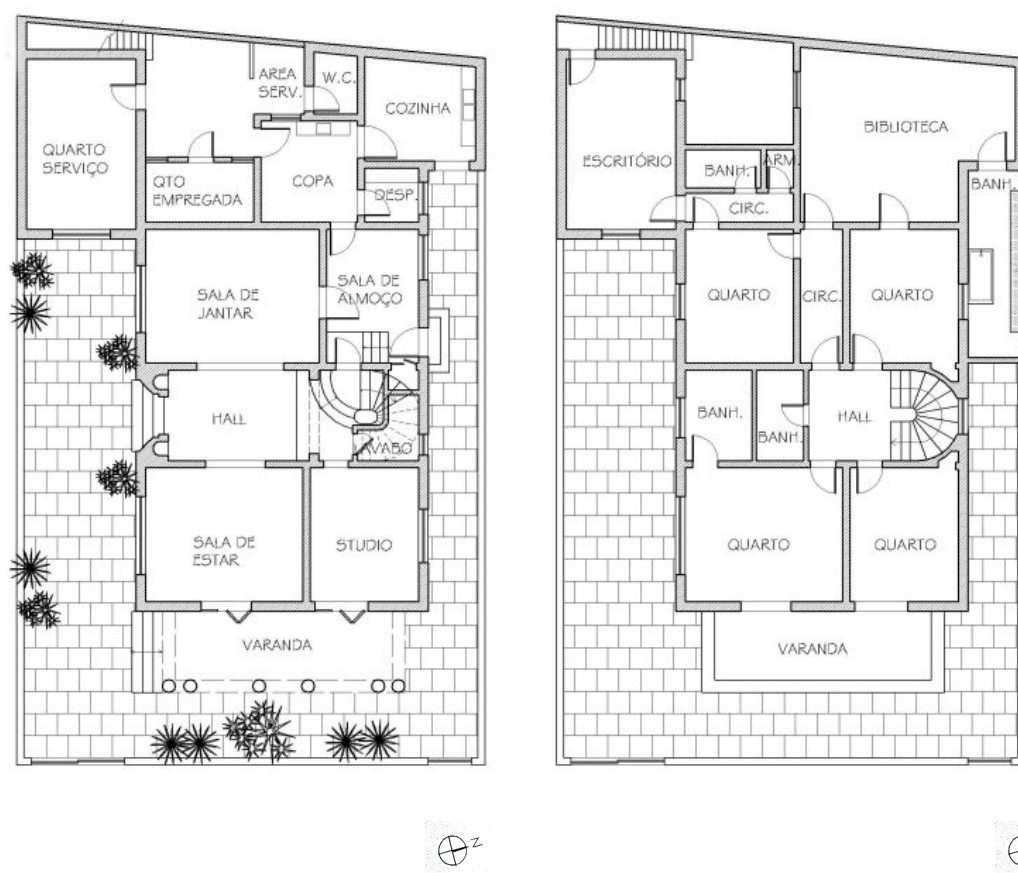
Plantas baixas atualizadas do pavimento térreo e do segundo pavimento.
